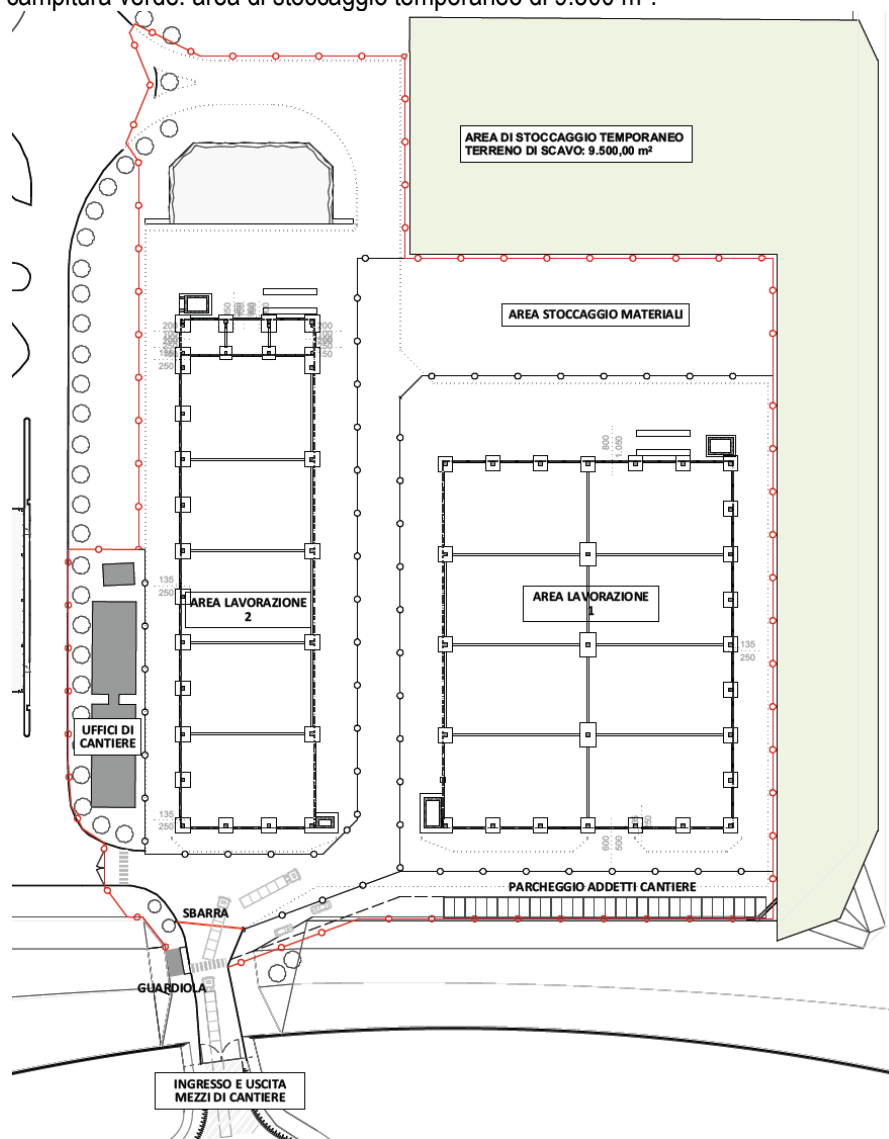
Planimetria di cantiere da estratto A.10 "Progetto: Movimenti terra e Sezioni ambientali".
